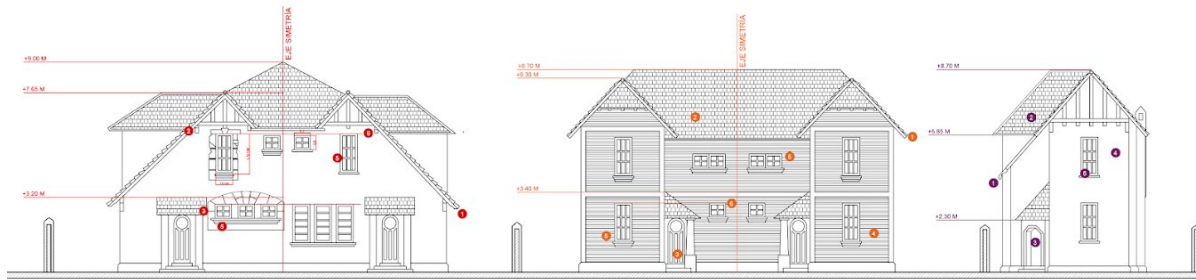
Levantamiento fachadas ZCH Población Salvador Legión Militar de Chile. Fuente: Departamento Barrios y Patrimonio.
